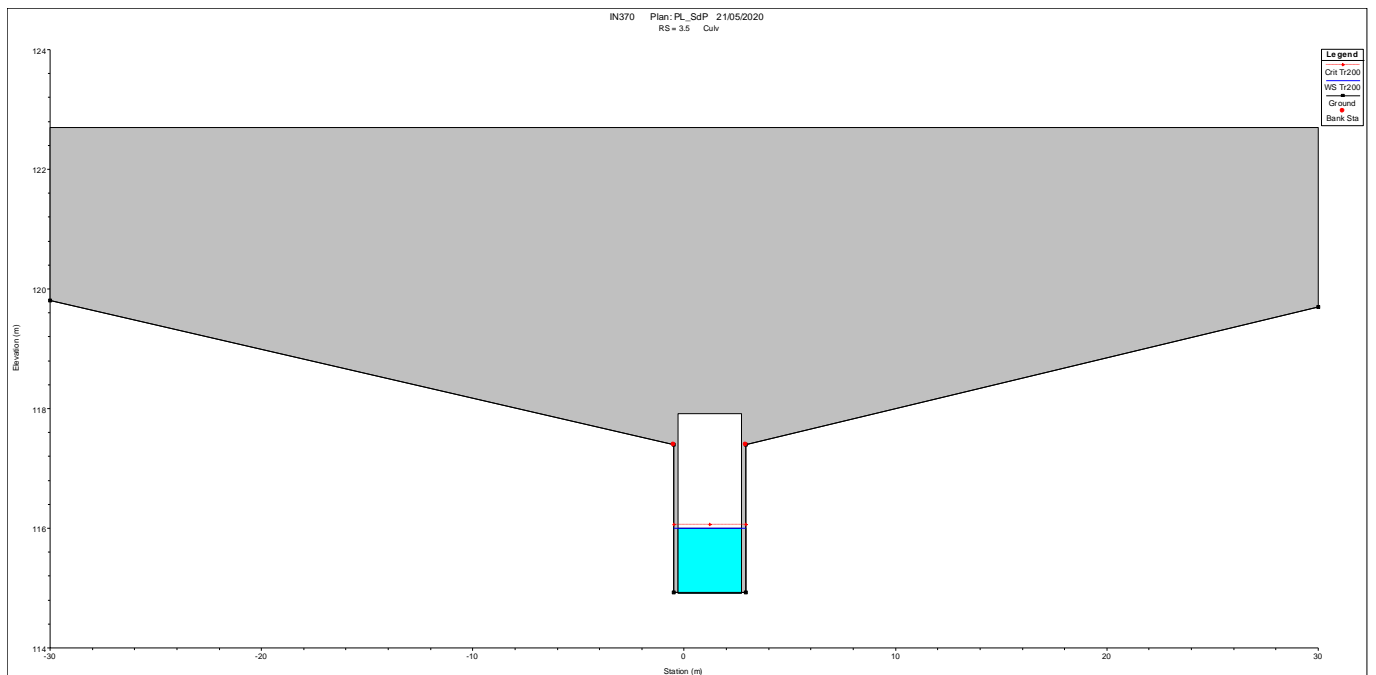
Sezione valle manufatto – stato di progetto interferenza IN370.
